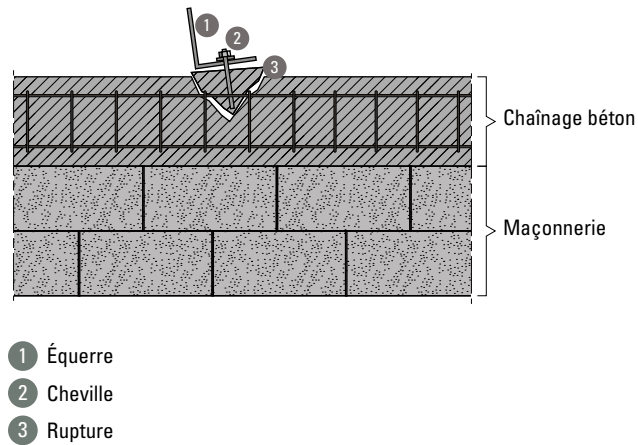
Exemple de rupture au niveau d'une fixation insuffisamment ancrée dans un chaînage
